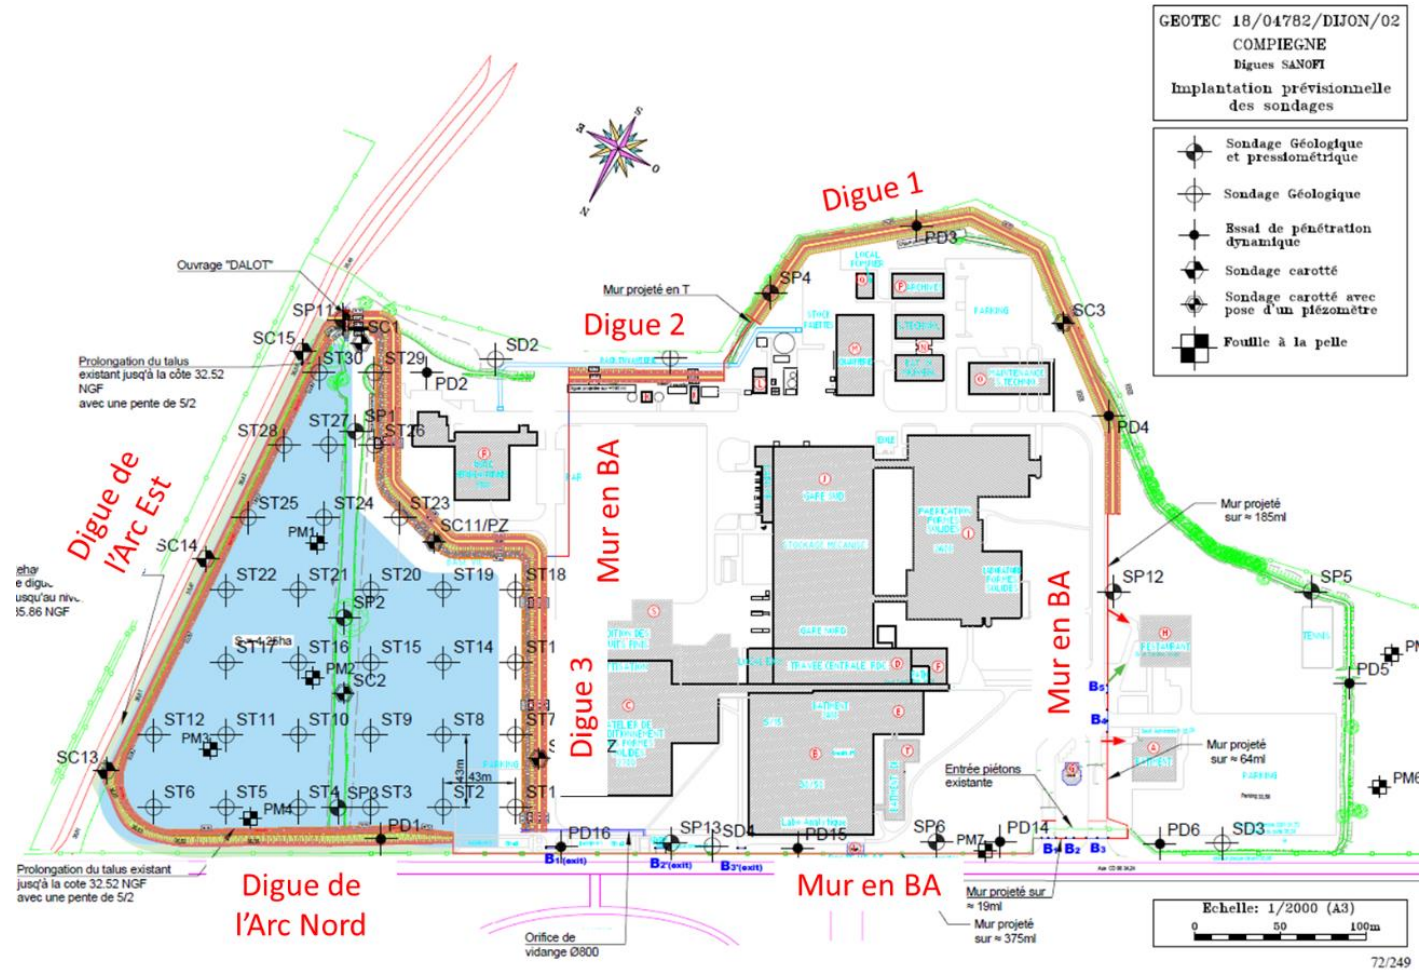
Plan d'implantation des sondages géotechniques (investigation 2021)
